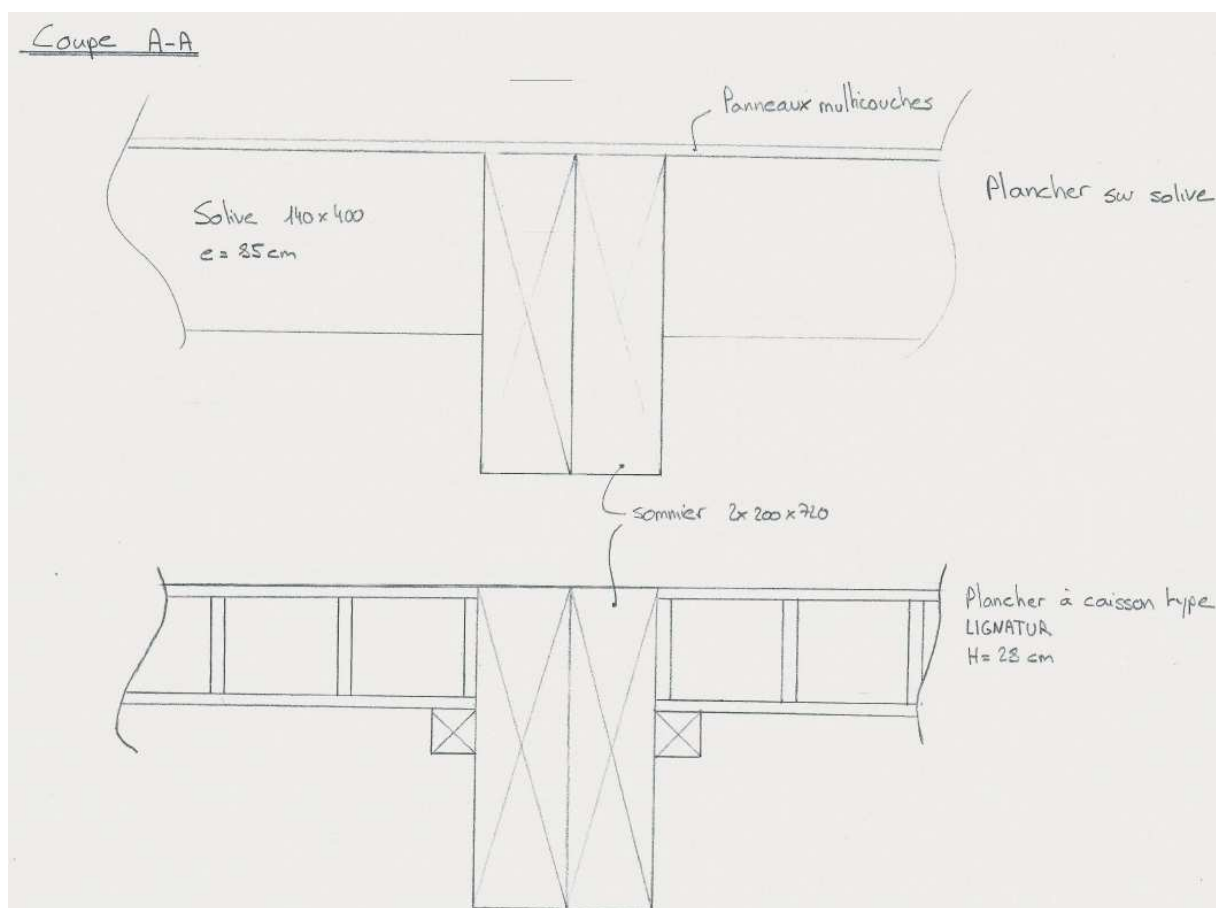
Proposition pour la surélévation en bois du hall du corps central - Coupe A-A
